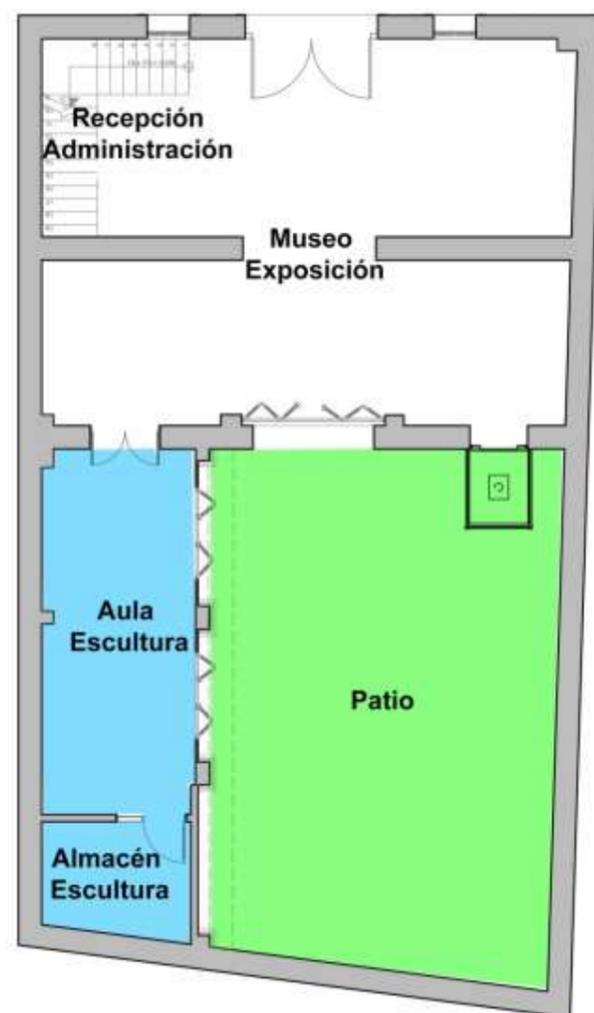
zonificación Planta Baja con el estado propuesto. Elaboración propia
